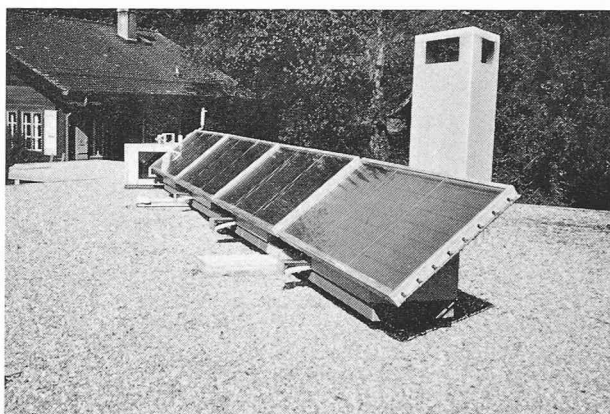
Installation des collecteurs sur le toit de la villa.
